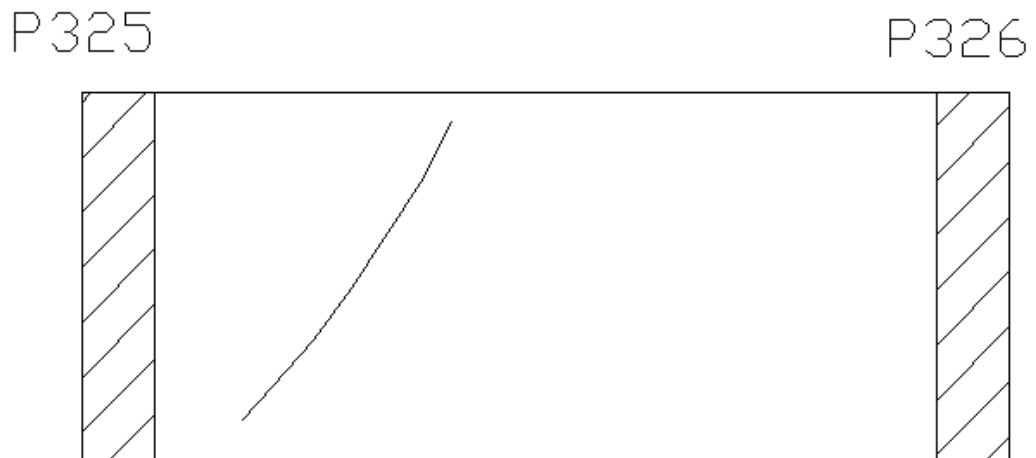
Esquema da trinca existente entre os pilares P325 e P326
